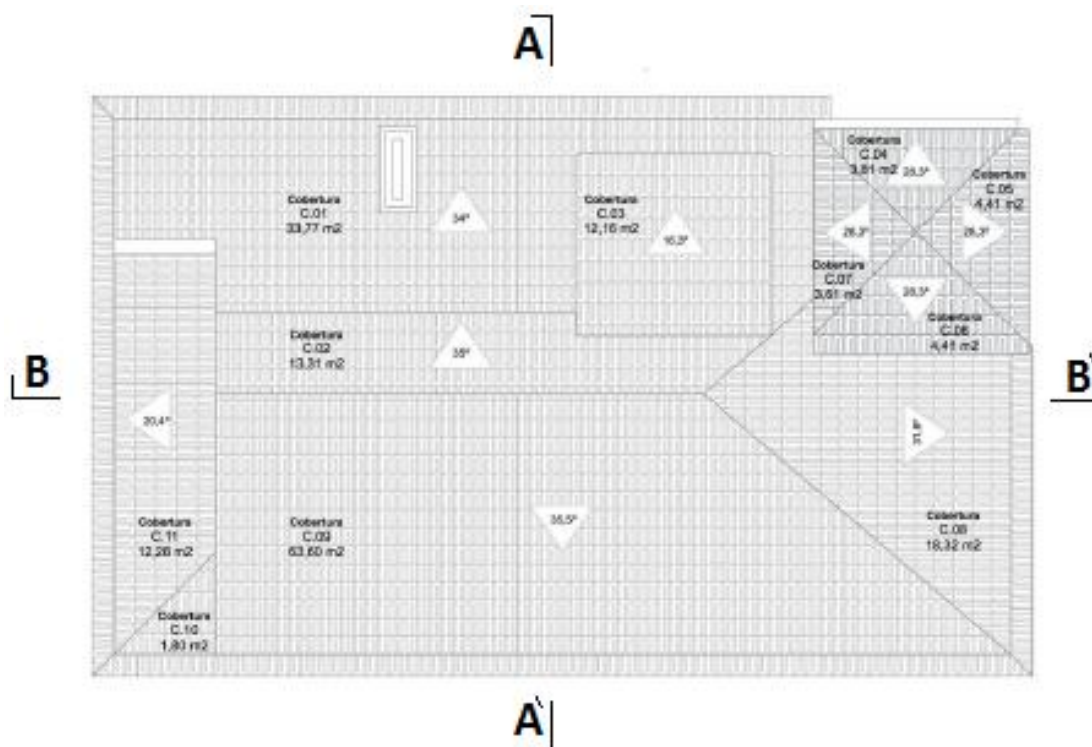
Planta de cobertura. Identificação da orientação e inclinação das pendentes
